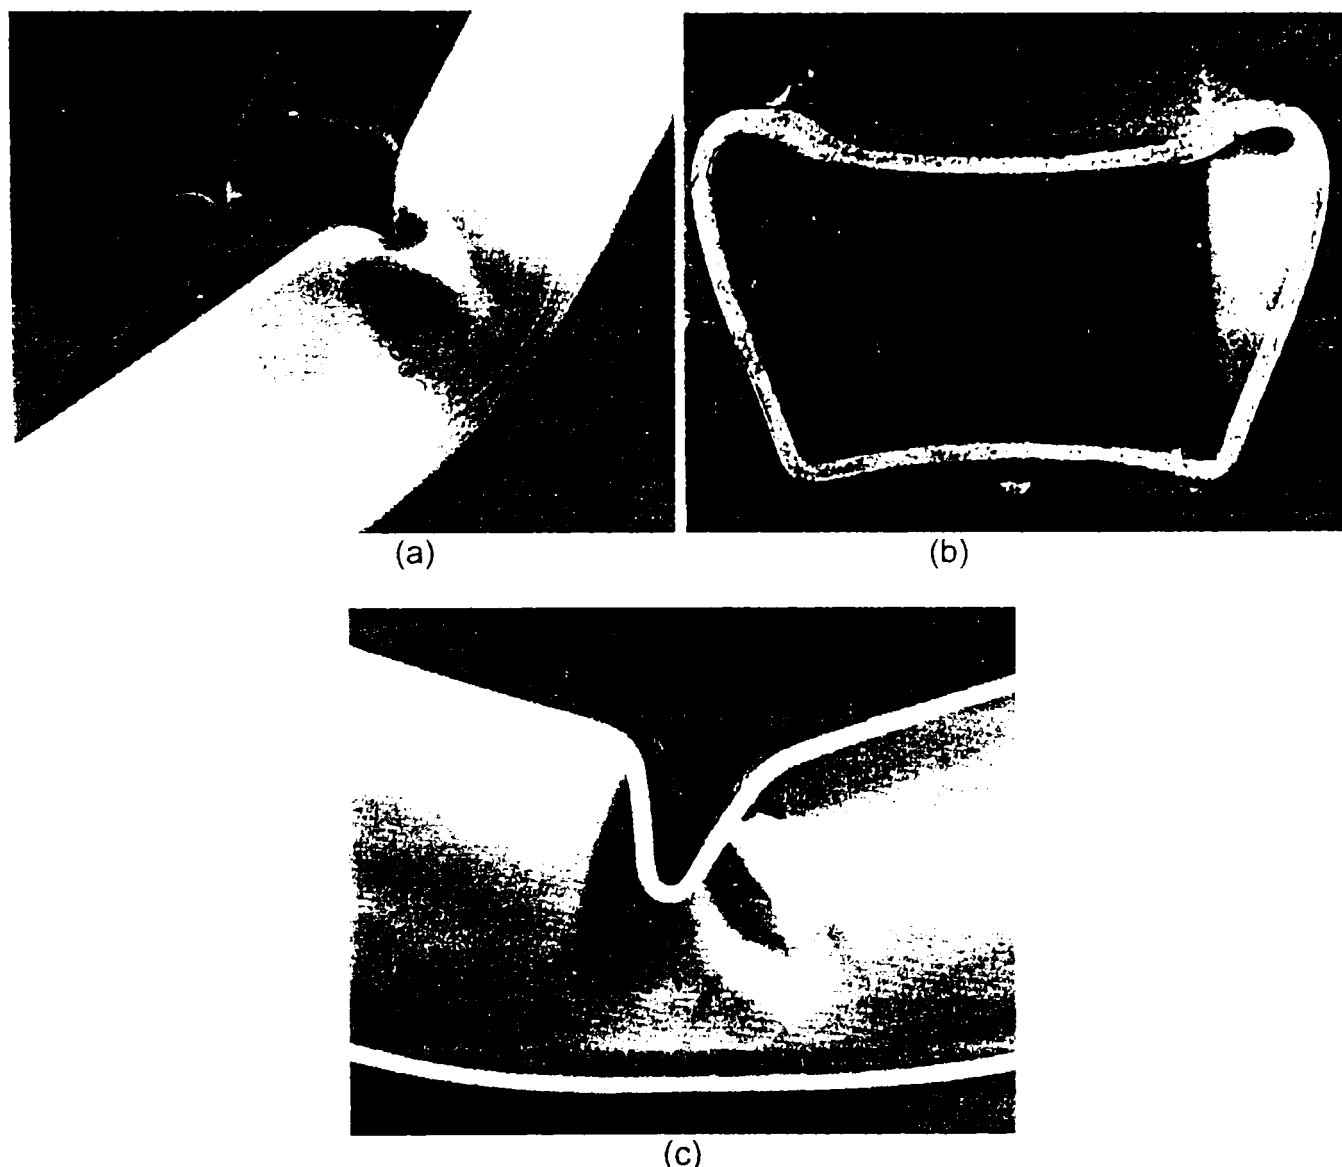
Mecanism plastic de încovoiere pentru o secțiune tubulară; (a) forma mecanismului; (b) secțiune transversală; (c) secțiune longitudinală
